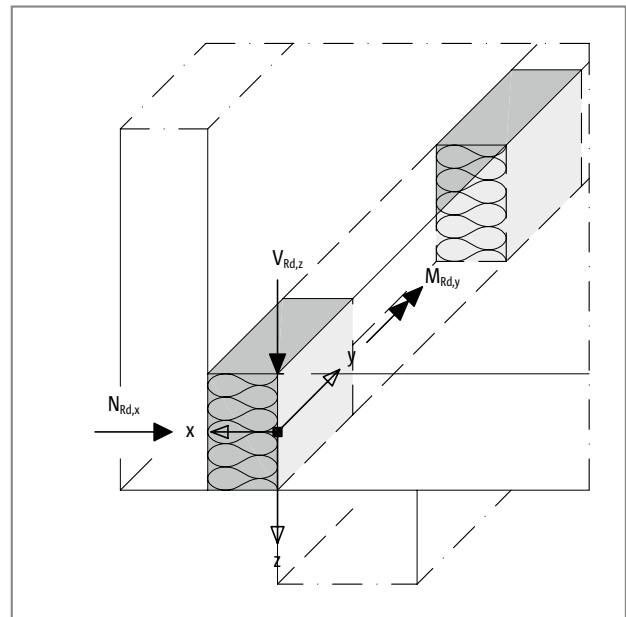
Schöck Isokorb® T tipo AP: regola dei segni per il calcolo dei parapetti antepesti
